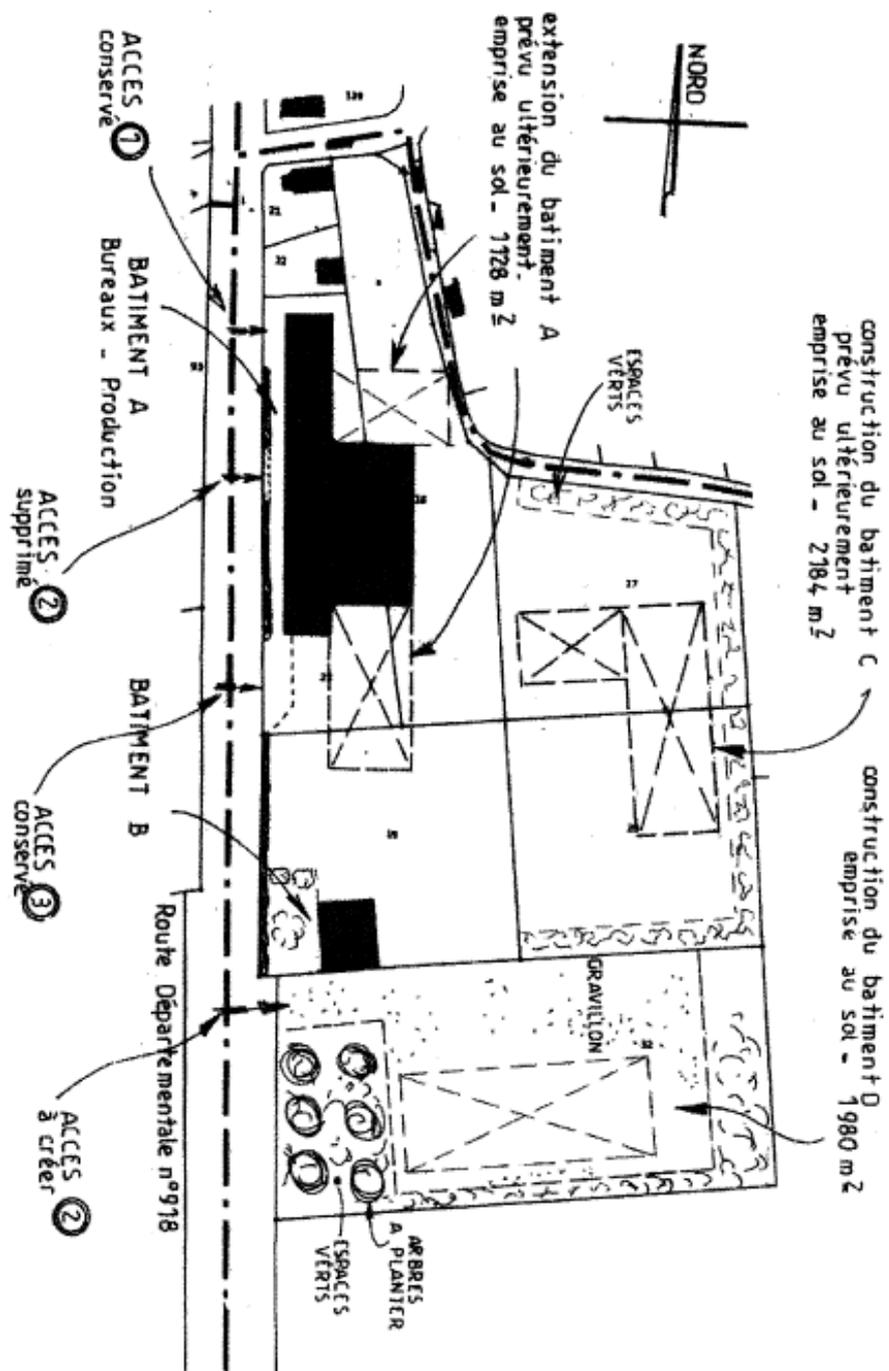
Plan de composition du projet d'extension de l'entreprise Lachaud
